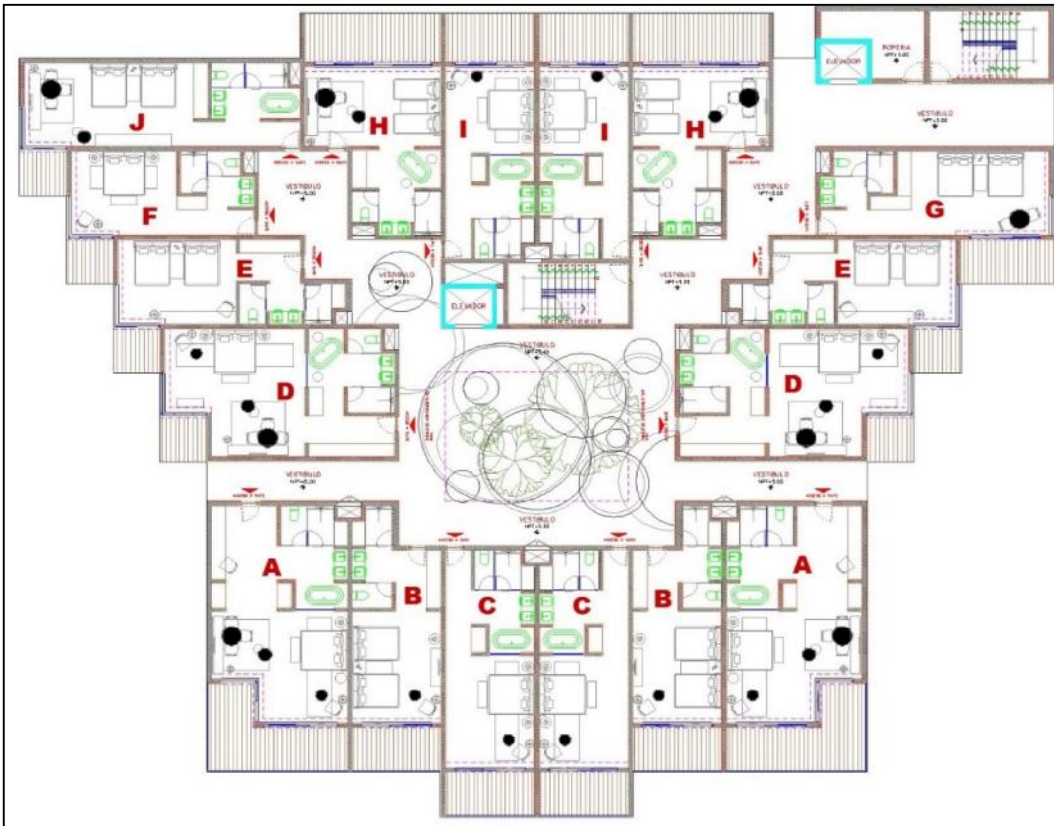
Edificio C, planta tipo (nivel 1 al 4).
